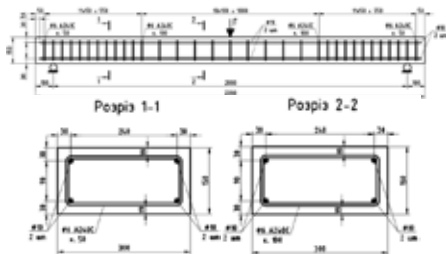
Конструктивна схема залізобетонної балки без підсилення
